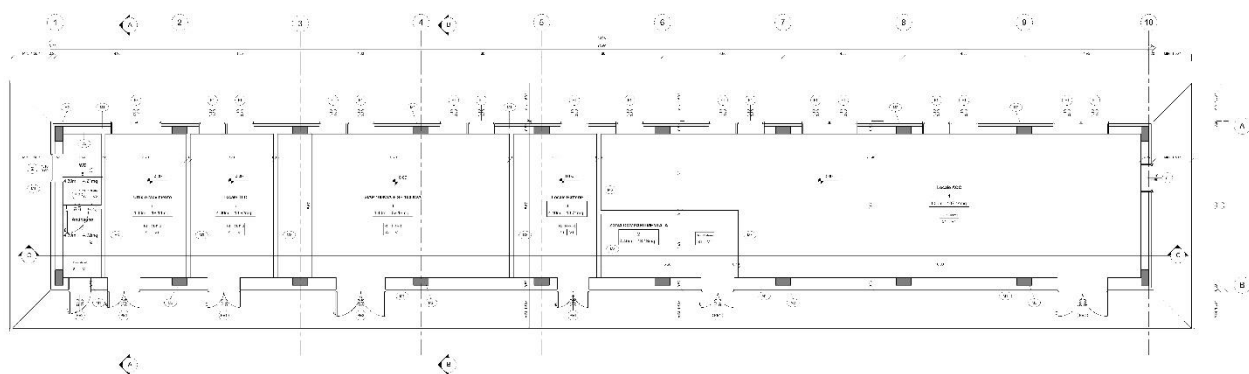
Pianta Architettonica Piano Terra – Layout T4_C
